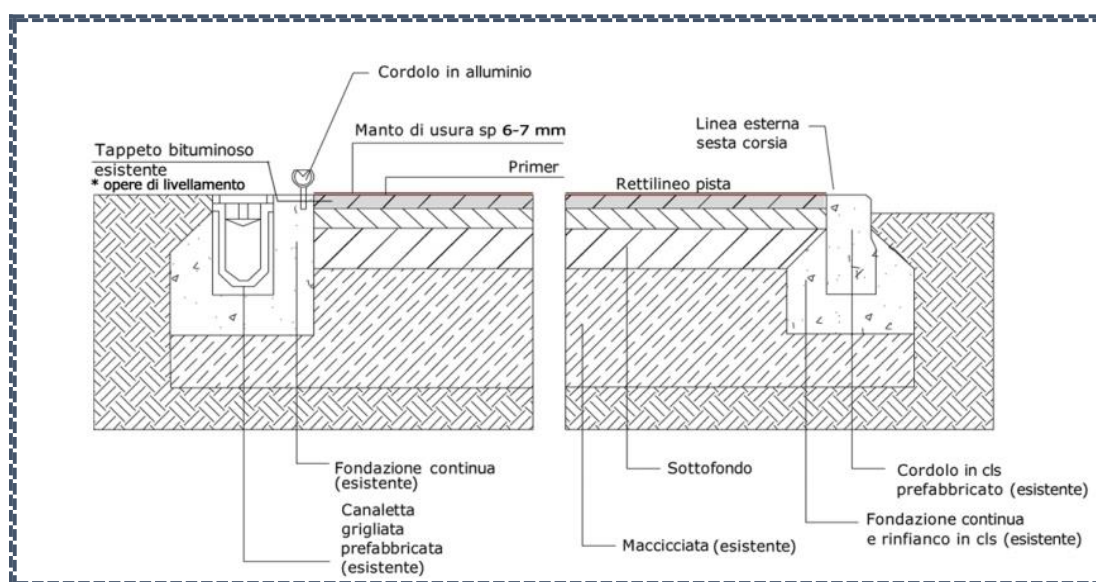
Estratto da Tav. 04 – Stato di progetto. Stratigrafia della pavimentazione della pista di atletica leggera.
